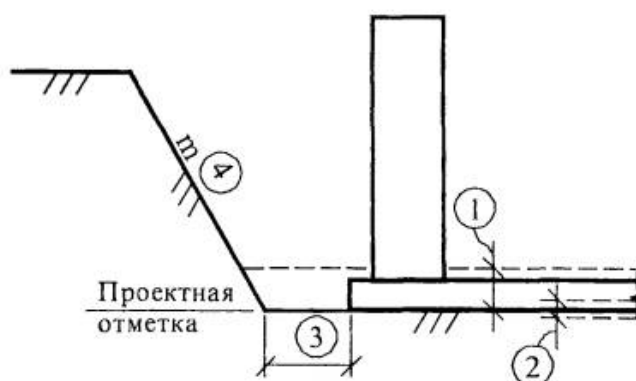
Контролируемые показатели при разработке грунта в котловане экскаваторами
